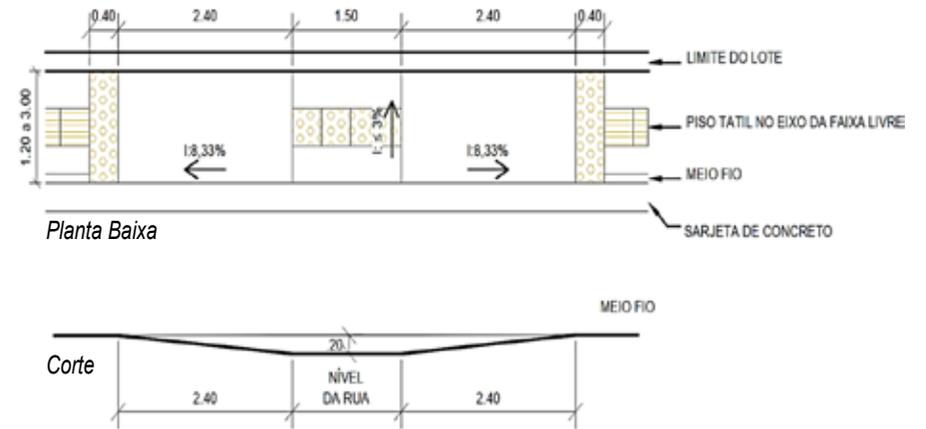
Planta baixa e corte da Rampa Longitudinal para Calçada com altura de 19 cm
